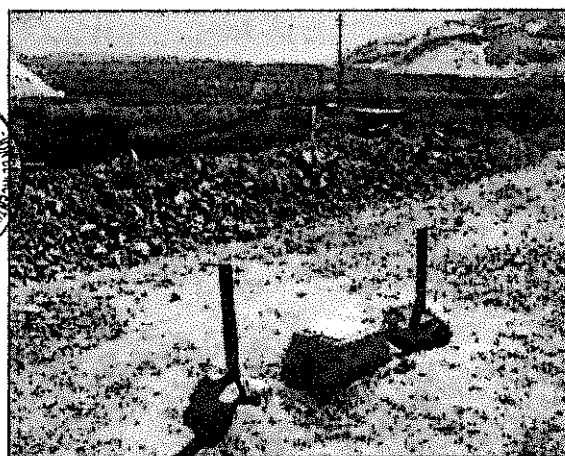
Instalación de Piezómetro PZ - 03, ubicado de la parte baja de las Pozas PLS-ILS.
